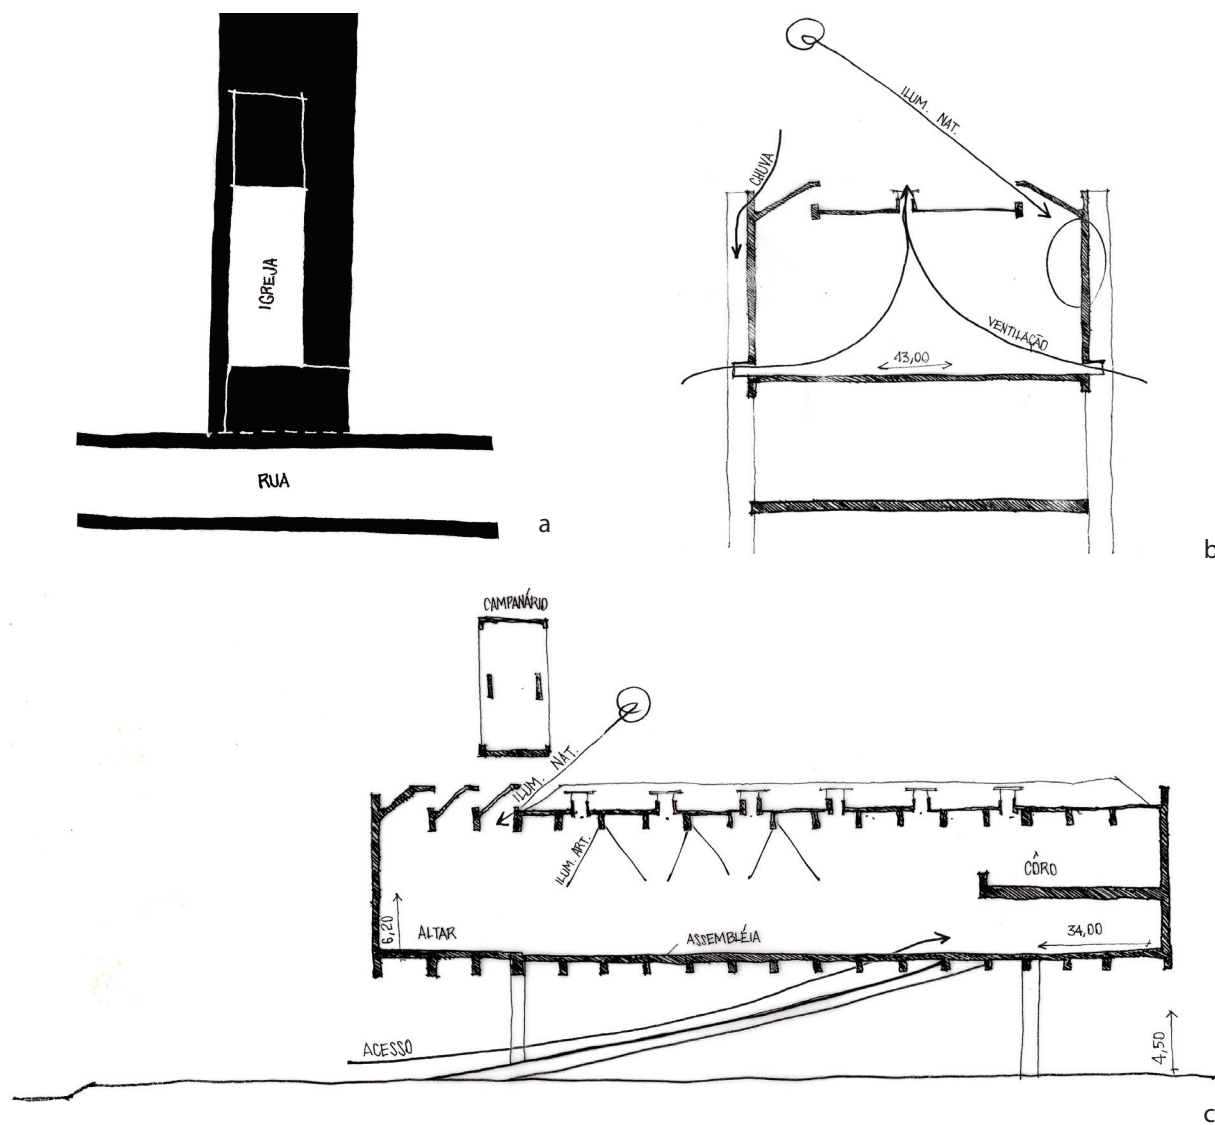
a - c: Desenhos do objeto, planta (a), corte transversal (b) e corte longitudinal (c). Fonte: do autor a partir dos desenhos de Paula Mastrocola.
